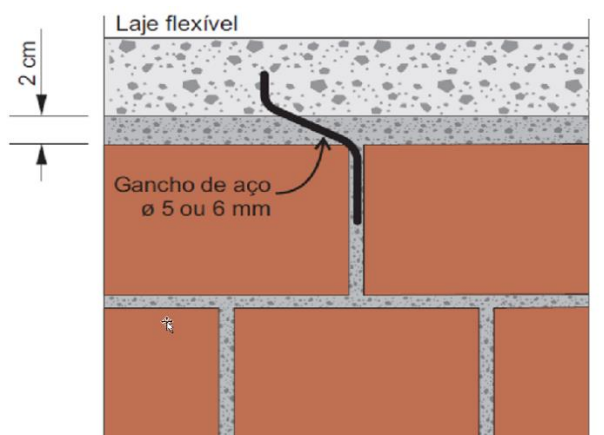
Encontro de alvenaria com laje ou viga deformável. Fonte: Adaptado de Thomaz et al. (2009).
